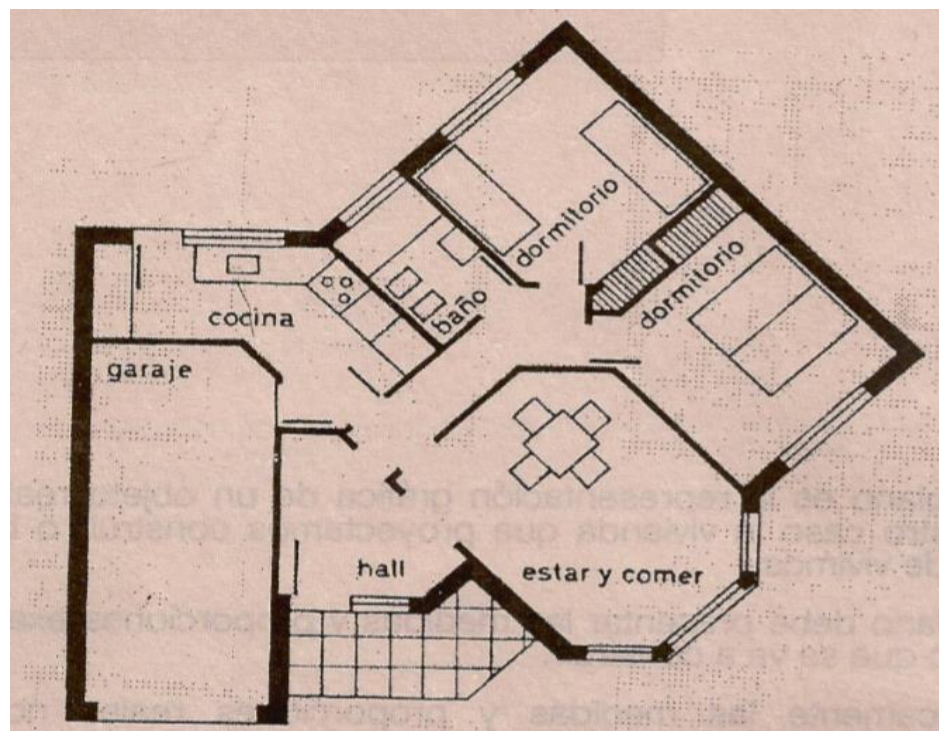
Plano de una casa. (Fuente: Interpretación de planos, manual auto informativo.)
